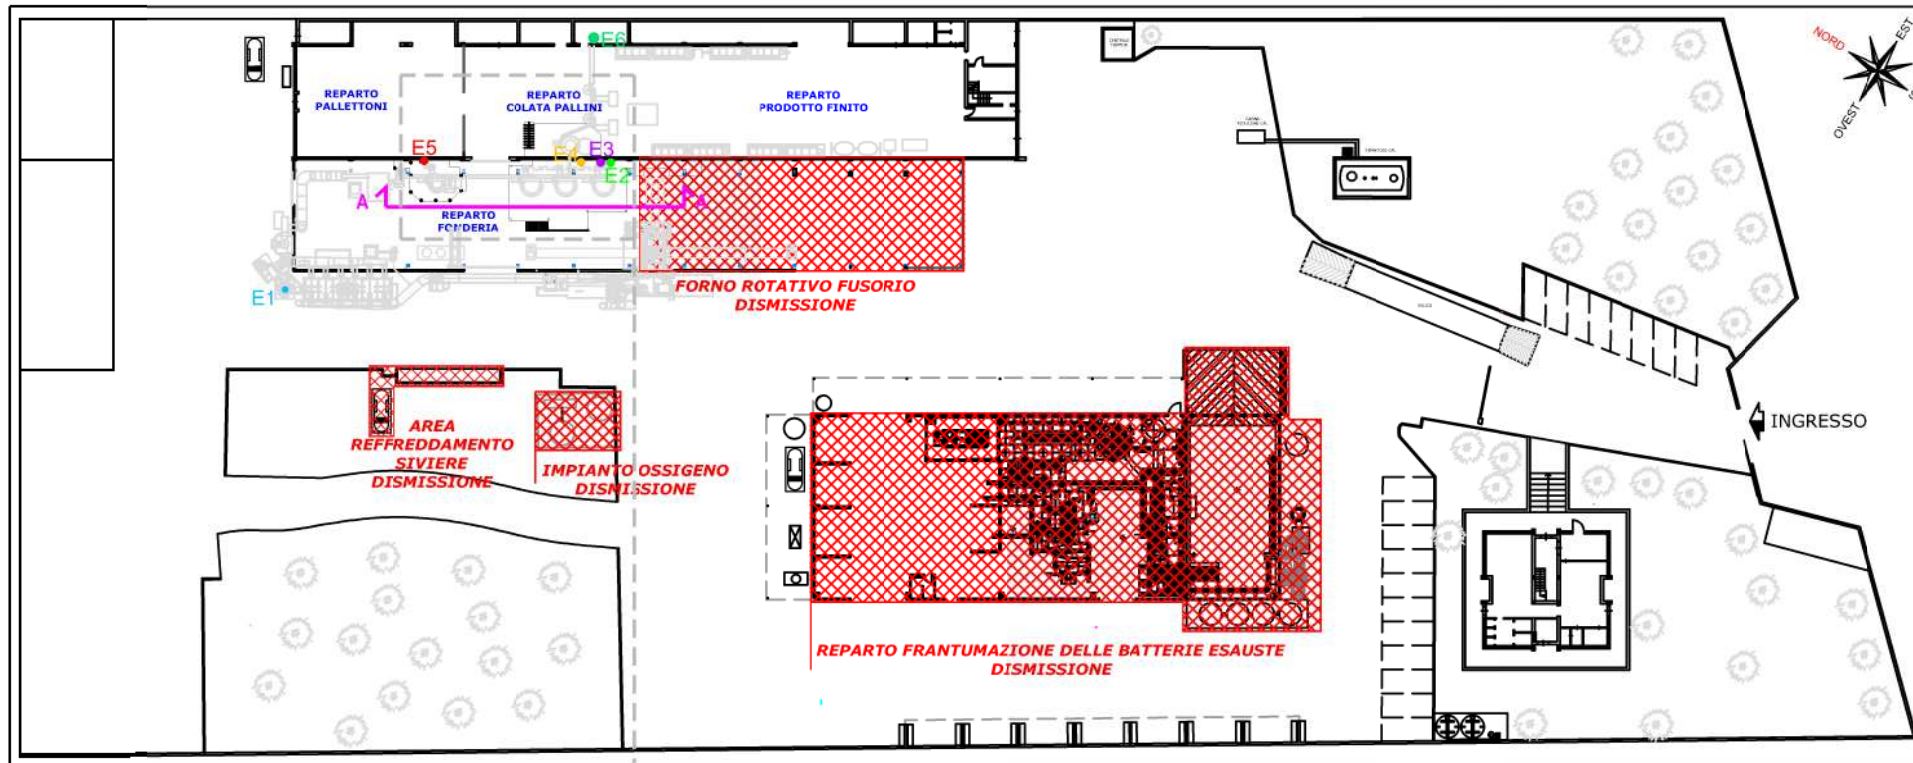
STRALCIO PLANIMETRIA GENERALE TEAM ITALIA
